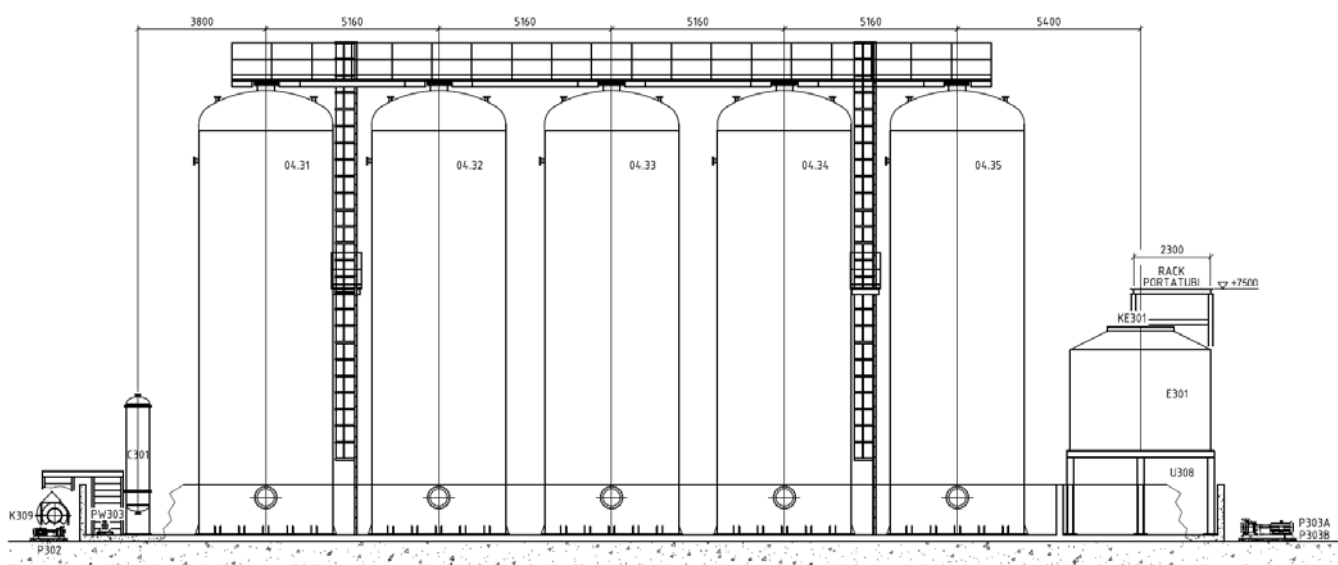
Prospetto longitudinale bacino di stoccaggio dei serbatoi di acido cloridrico.
